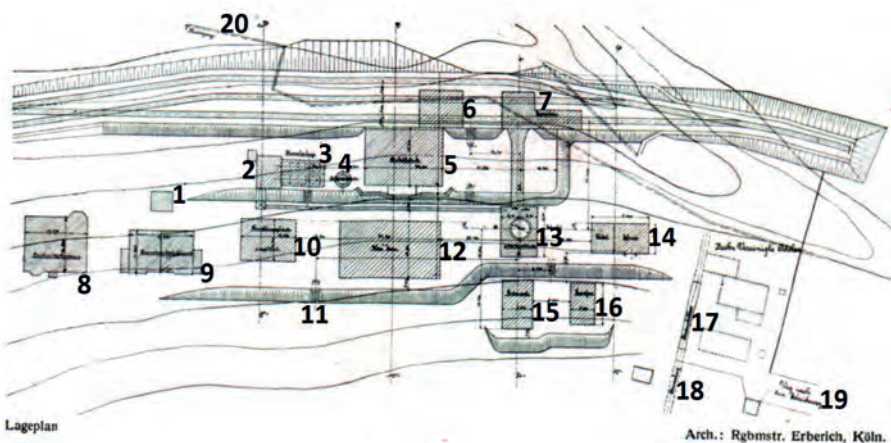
Glückauf Barmen Lageplan (aus ERBERICH 1911a: 86)
